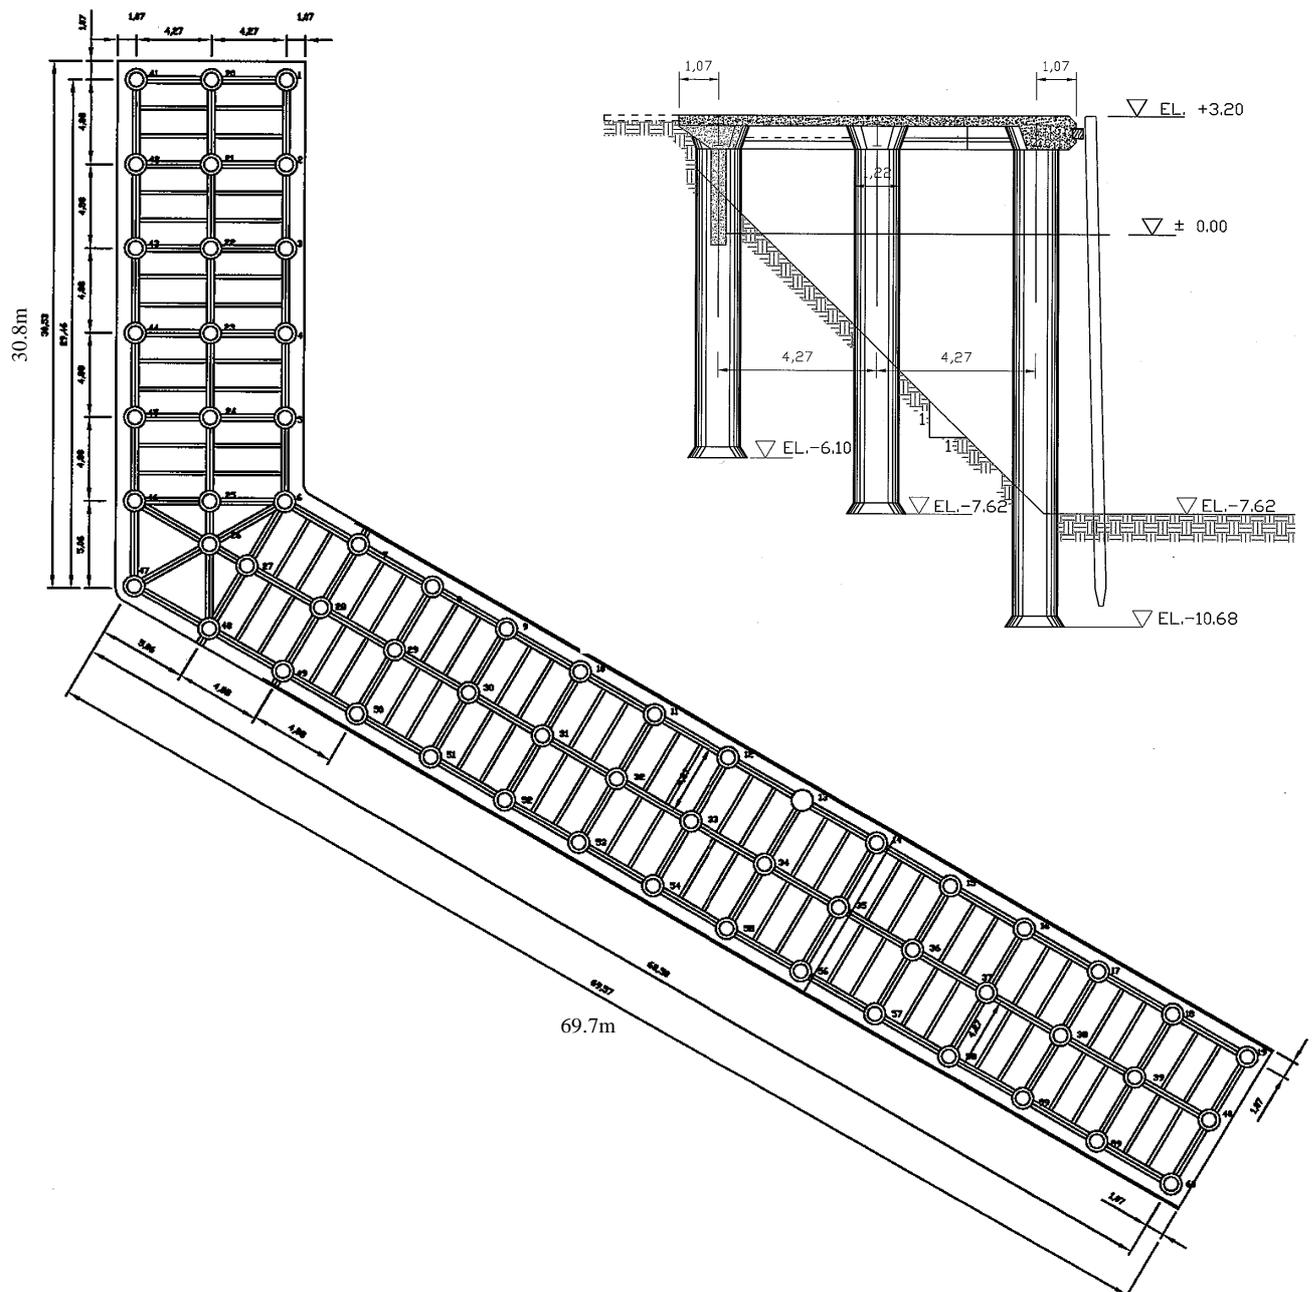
Plan típico y sección de Estructura de Muelle Existente
